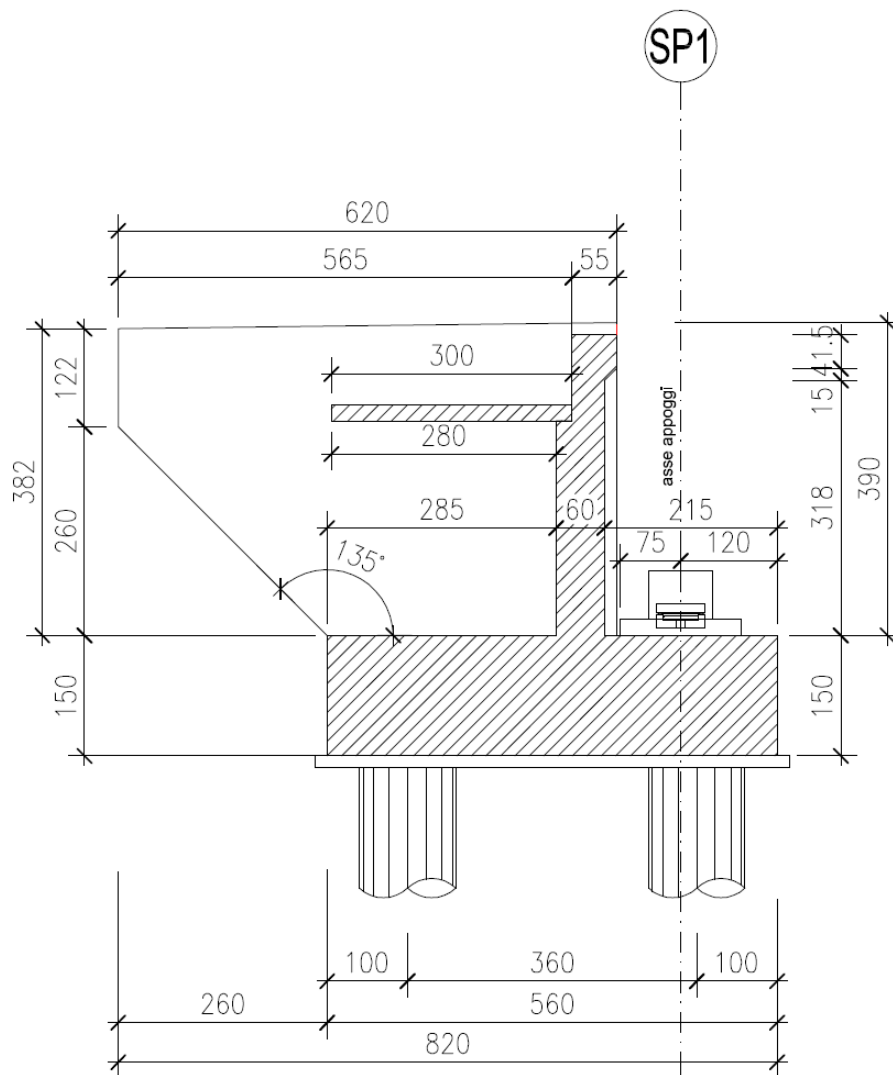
SEZIONE TRASVERSALE SPALLA
